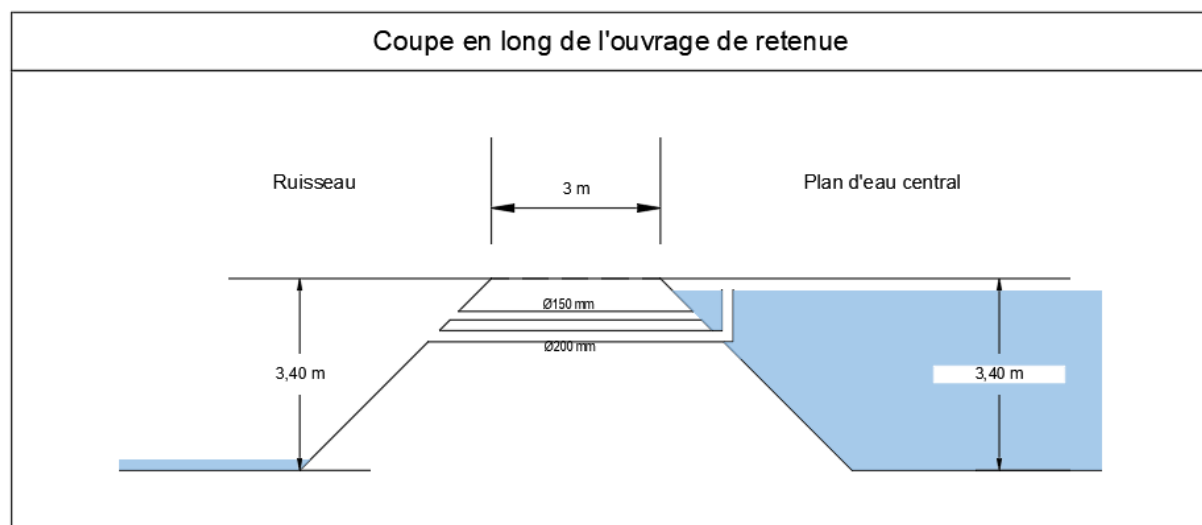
Coupe en travers de l'ouvrage de retenue du plan d'eau Central
